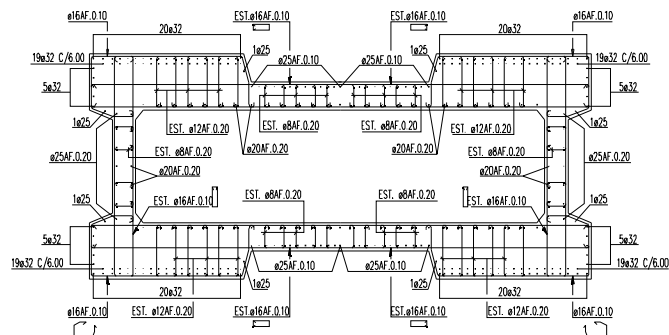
Armadura longitudinal e transversal dos pilares P6 e P8 a P14.
